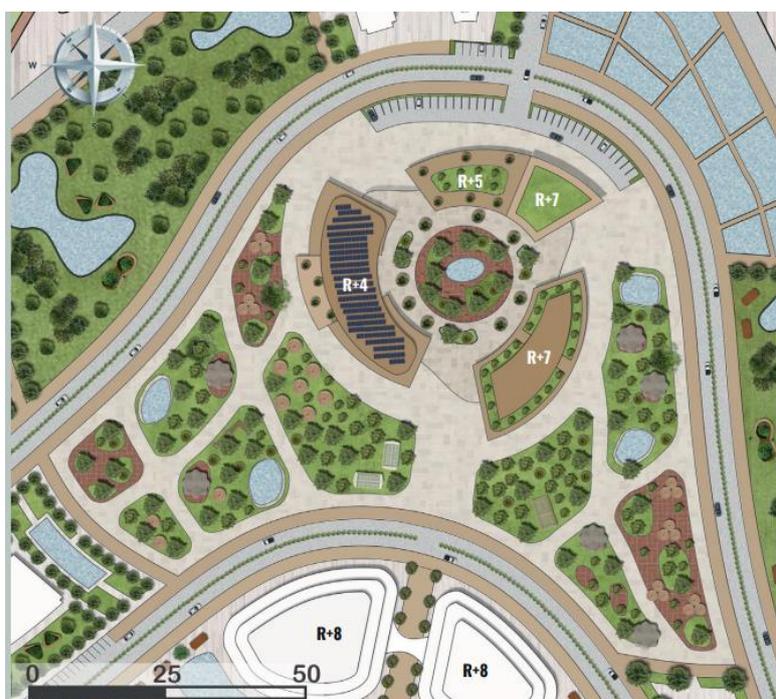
Le plan de masse du VORTEX source : auteur 2024
